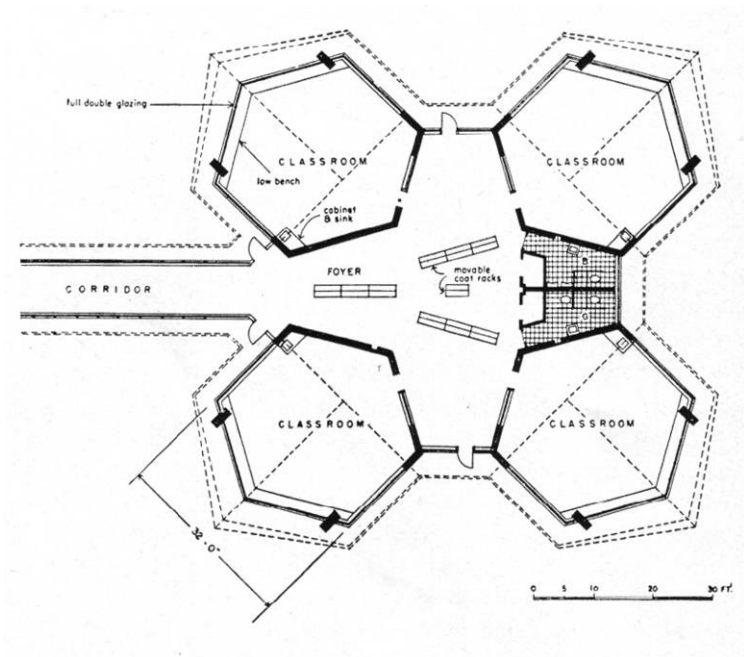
Perskins & Will, Heathcote Scholl, New York. 1951-54. Planimetria tipo dell'unità-aula.
